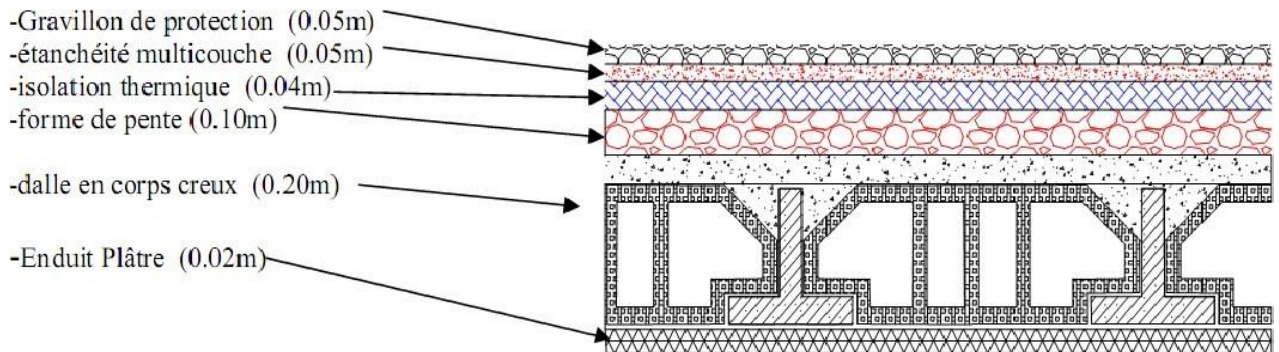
Coupe verticale de plancher terrasse à corps creux
